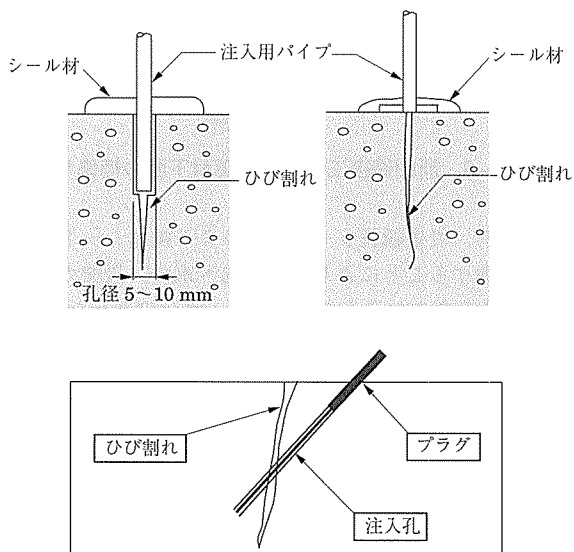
注入工法によるひび割れ補修⁴⁾
